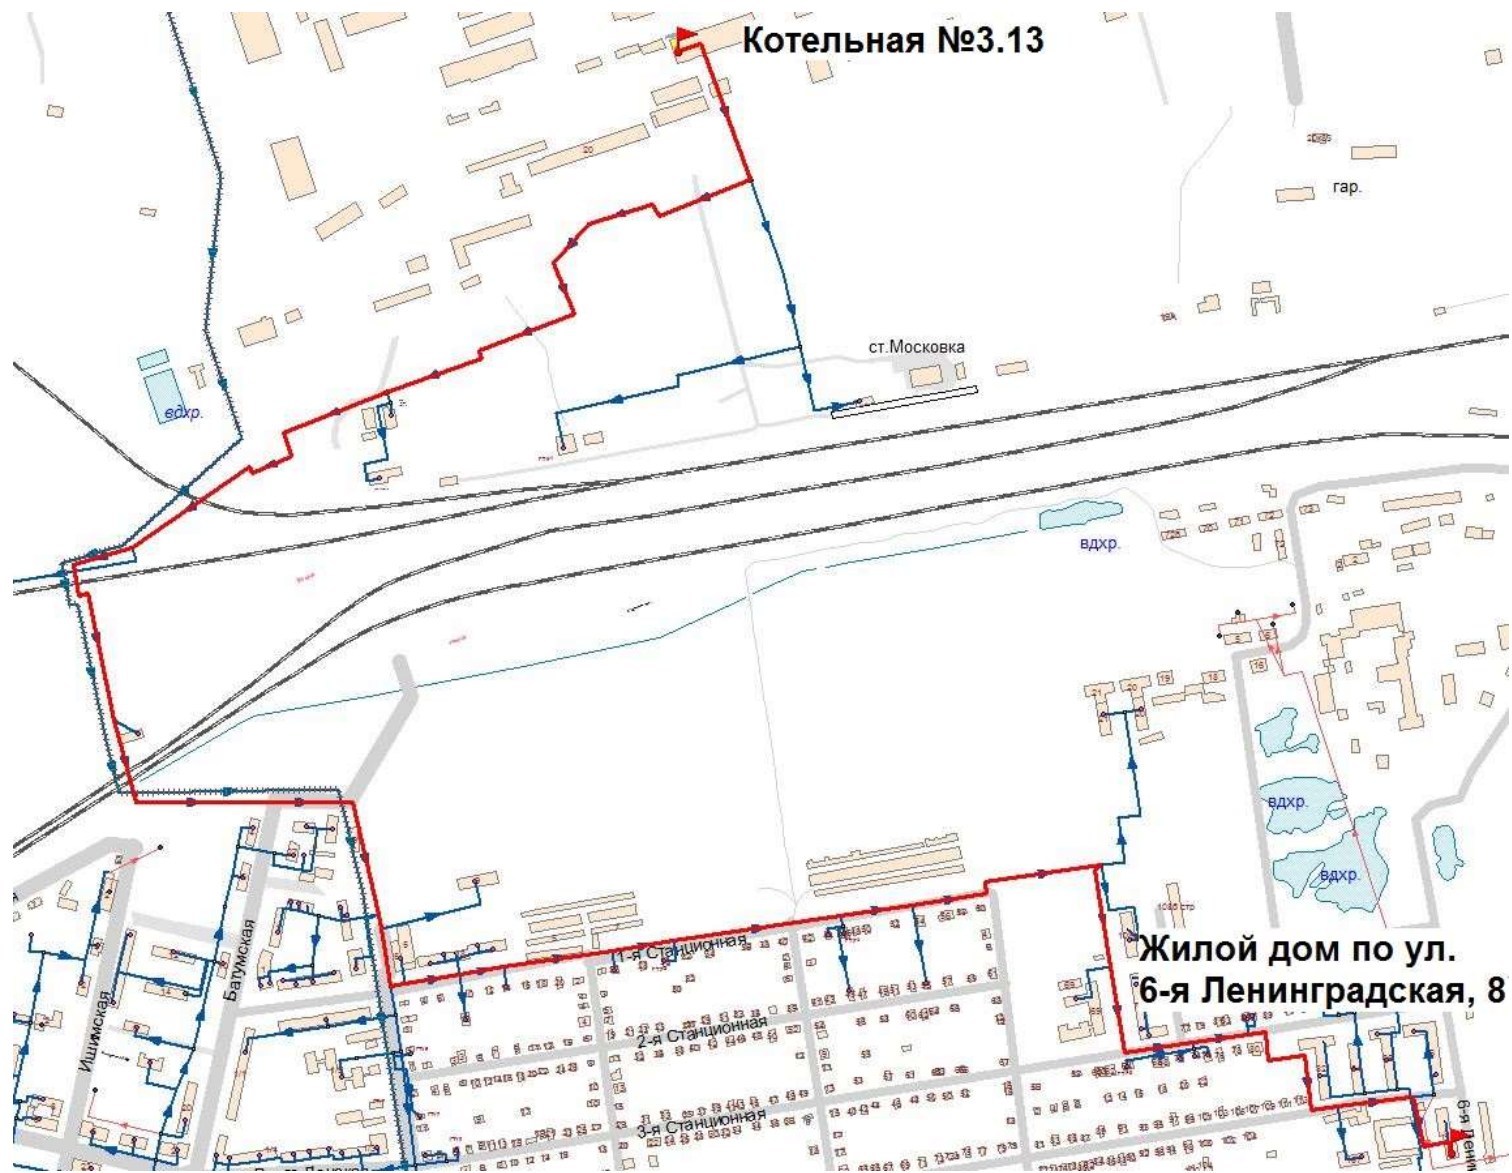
Трассировка теплопровода от Котельной 3.13 до жилого дома по ул. 6-я Ленинградская, 8
